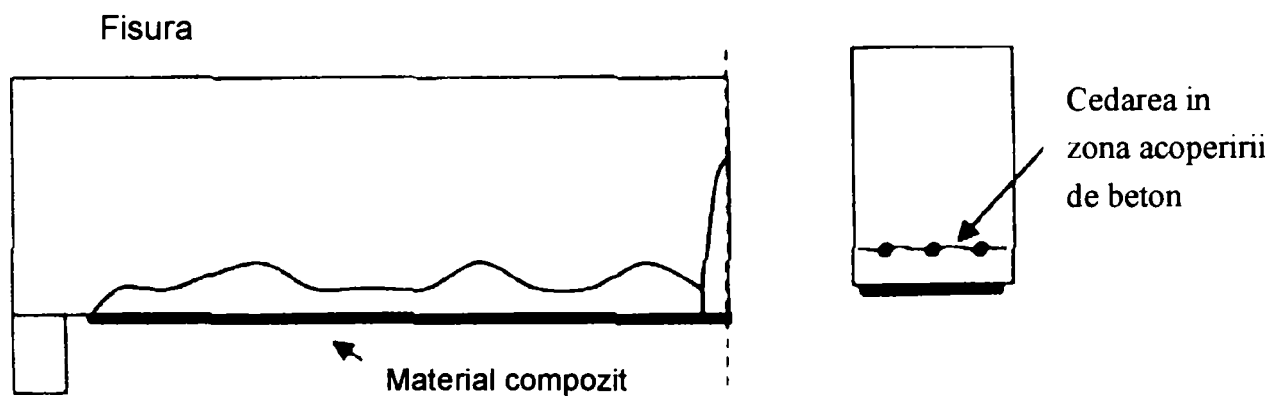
Delaminarea cauzată de cedarea la întindere a stratului de acoperire cu beton
